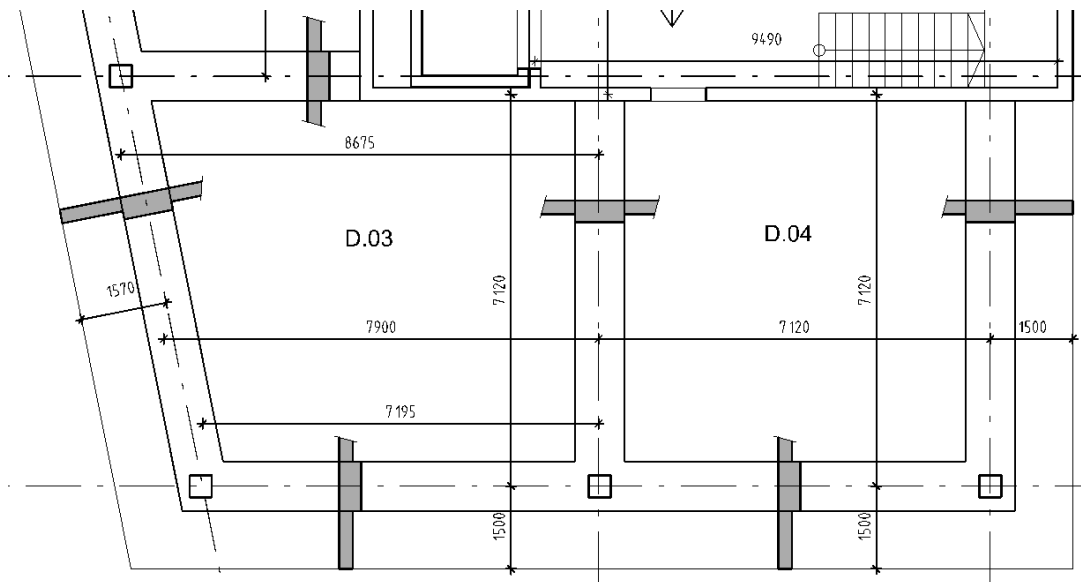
konstrukční schéma stropní konstrukce 1.NP
